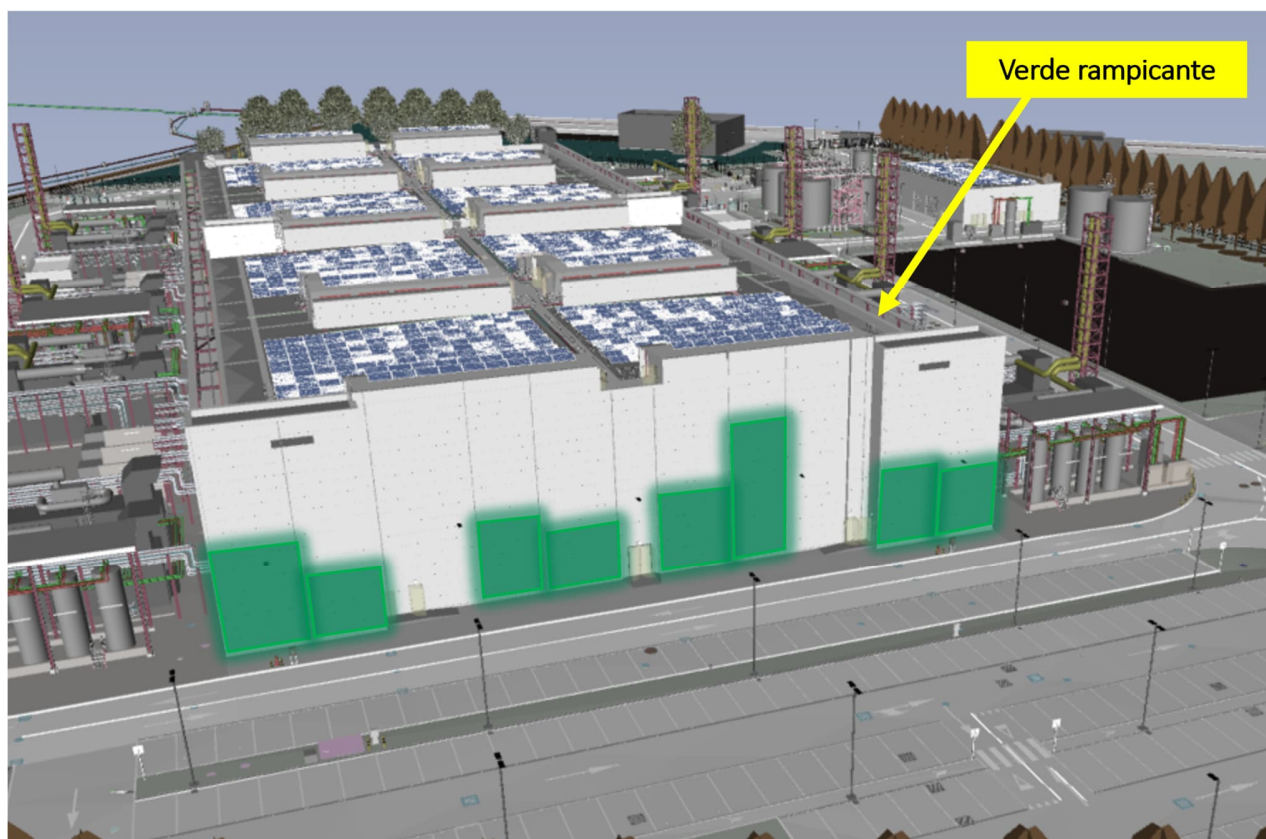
Rendering di impianto con gli interventi a verde verticale previsti – vista lato sud dell'impianto.
